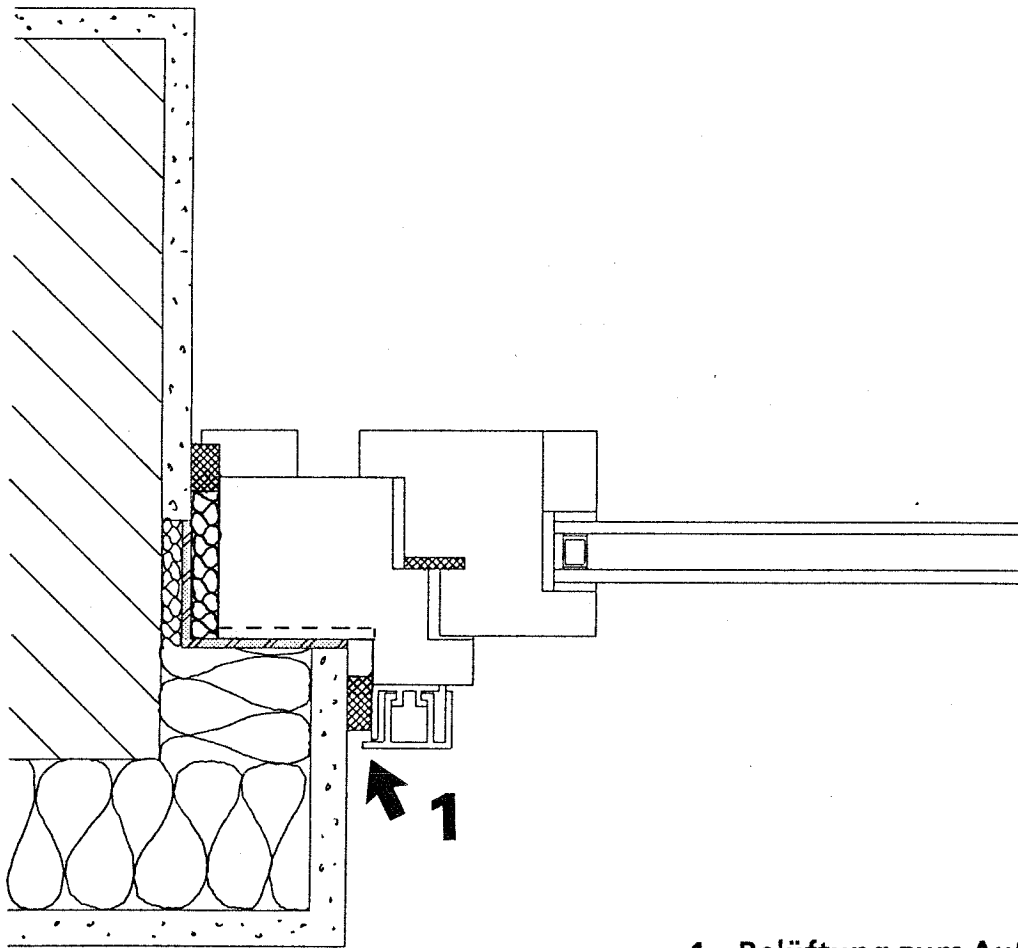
Beispiel für eine Eckzarge mit Kunststofffenster bei zweischaliger Außenwand mit Fassadenbekleidung
